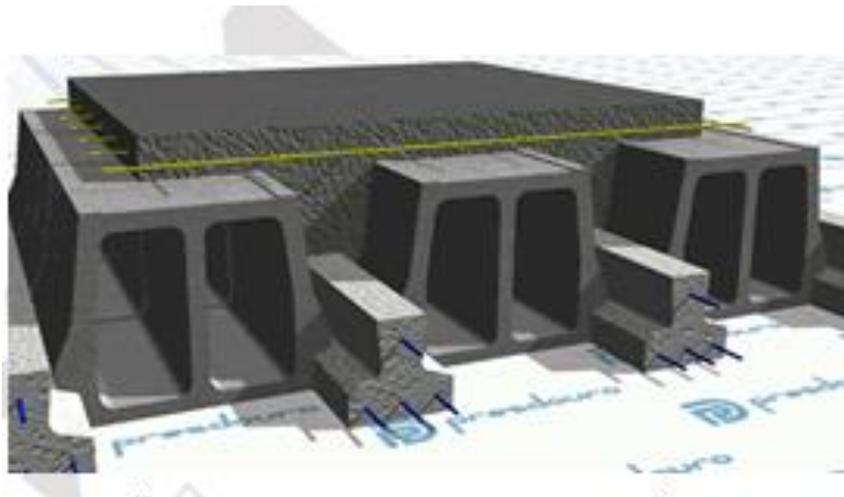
Fuente: "Construção e Arquitectura Sustentáveis em Cabo Verde"
